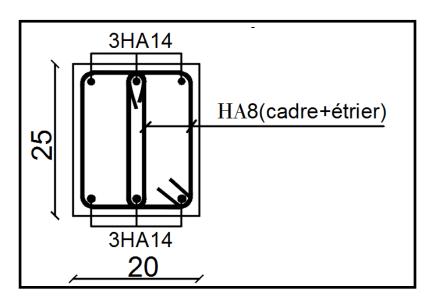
Ferraillage aux appuis d'une poutre de chainage
